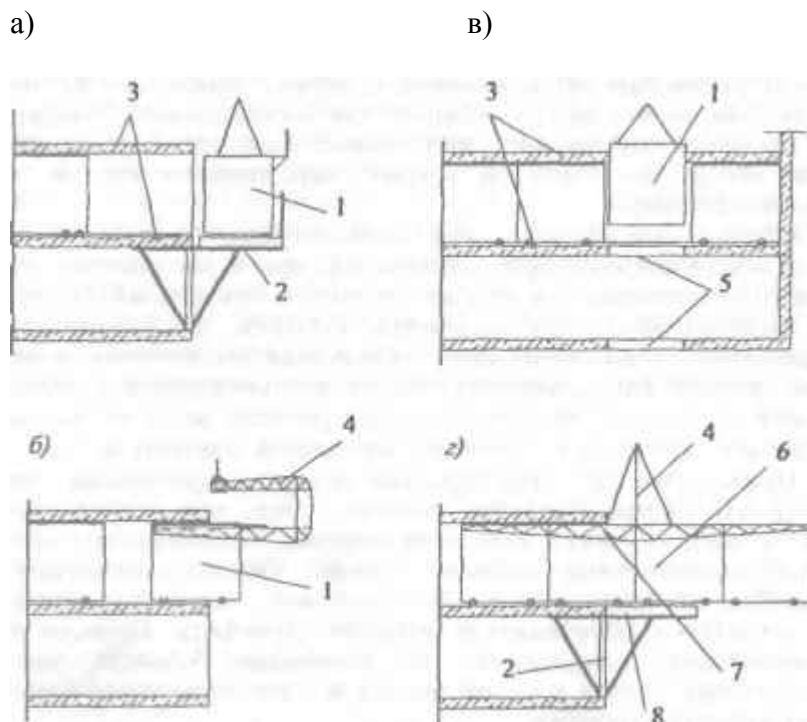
Схема демонтажа объемно-переставной и туннельной опалубки:
